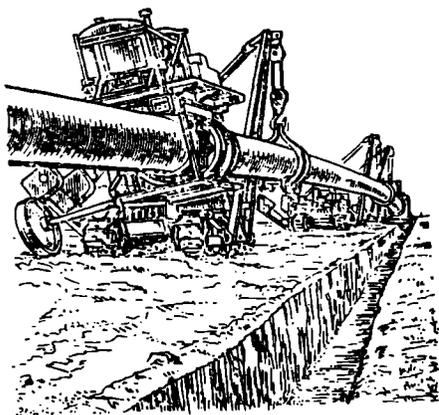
Колонна кранов-трубоукладчиков на изоляционно-укладочных работах
